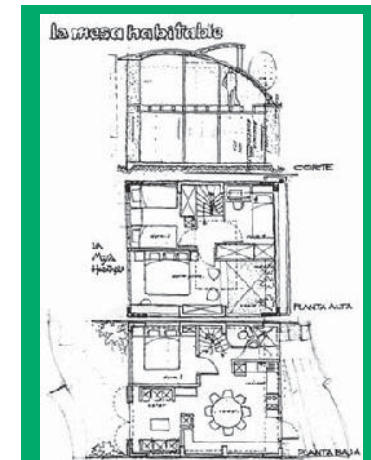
LA MESA HABITABLE, PLANTA Y SECCIÓN
